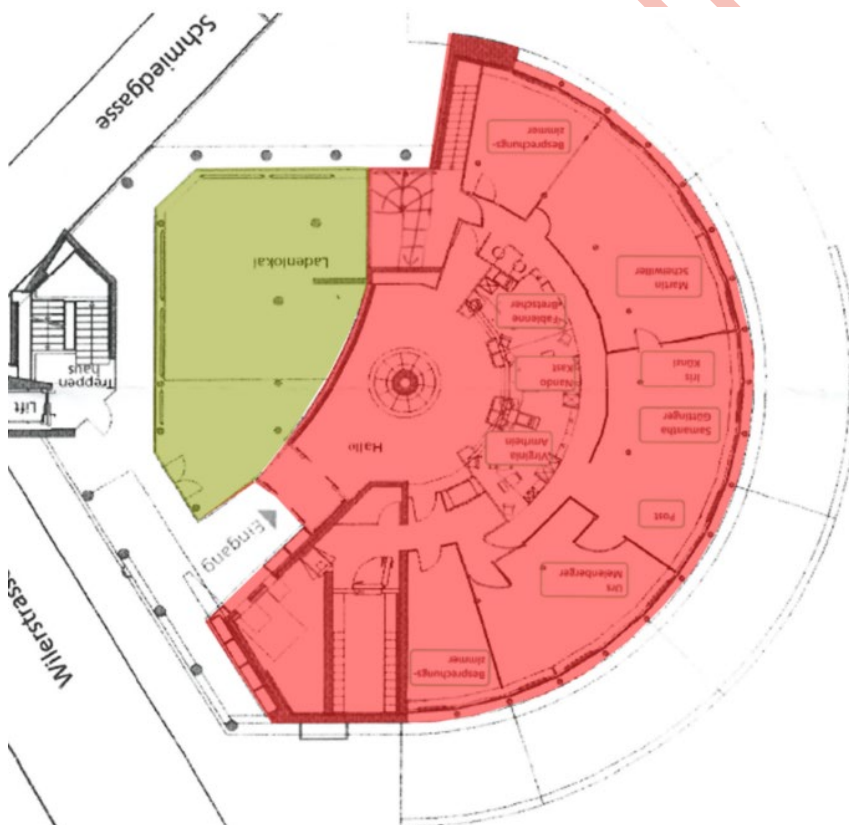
Grundriss Erdgeschoss Sirnach (ohne Massstab)
